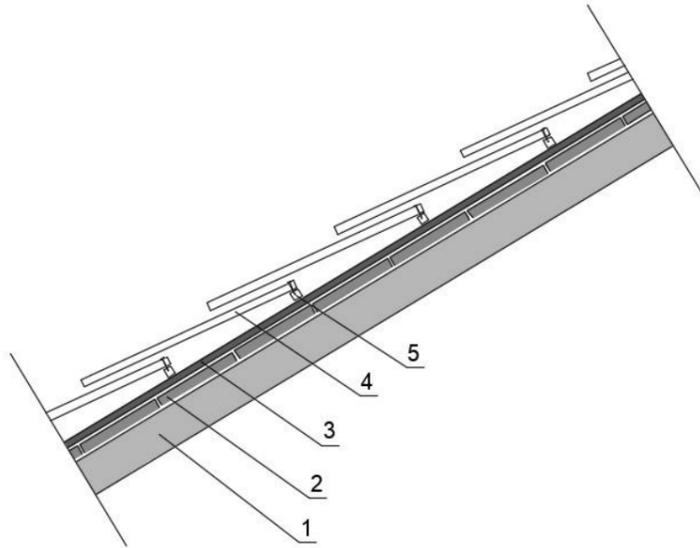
Estación Central de Amberes. Recreación cubierta. Fuente: Propia. Escala: 1:20.
